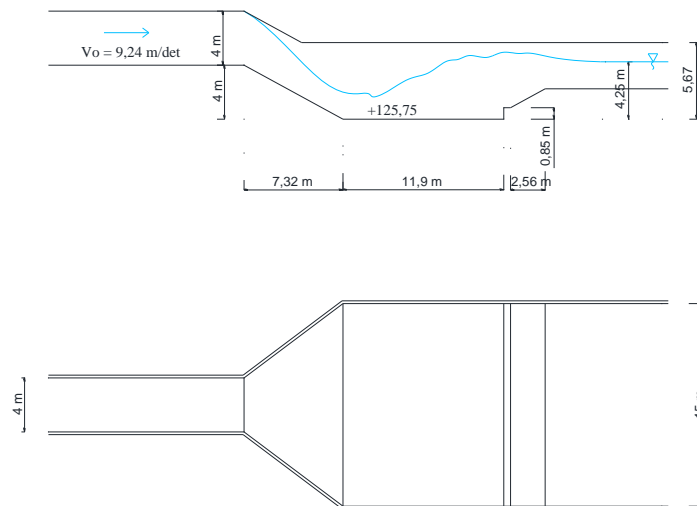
Sketsa detail elevasi *Spillway*, konduit ,dan tubuh bendungan
